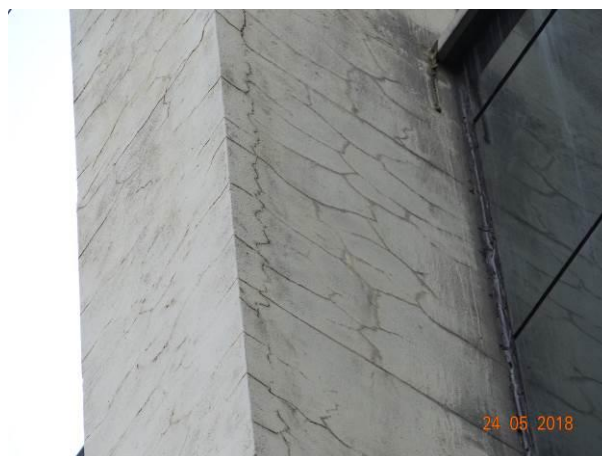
Fissuras aleatórias na face Oeste do pilar P13.
